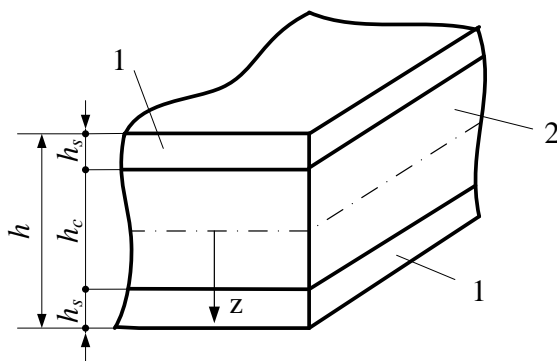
Поперечное сечение плиты: 1 – стальной лист, 2 – бетон
